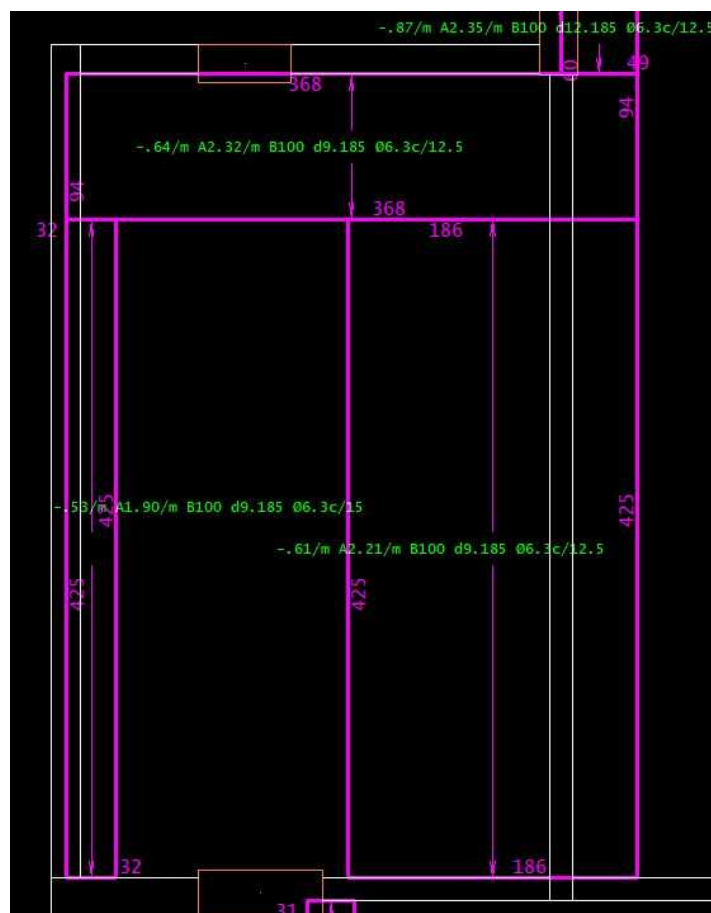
Armaduras negativas horizontais para a L5 do 3º Pavimento antes das alterações
